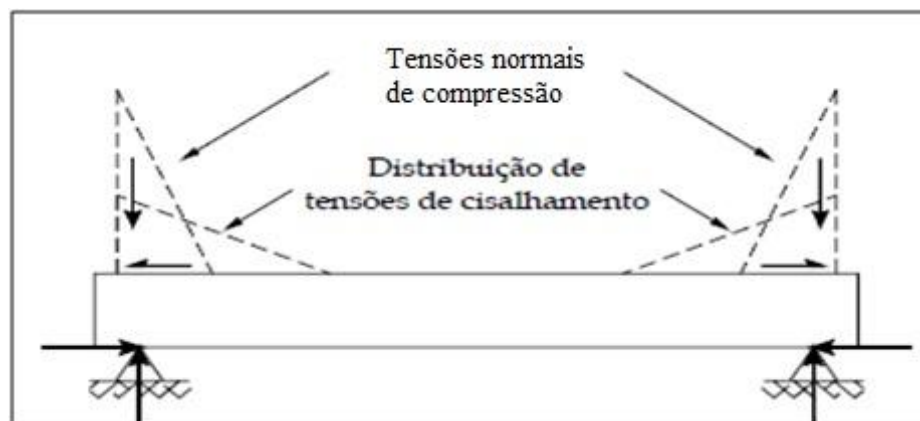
Concentração de tensões nos apoios da viga. (Fonte: Silva, 2005)
